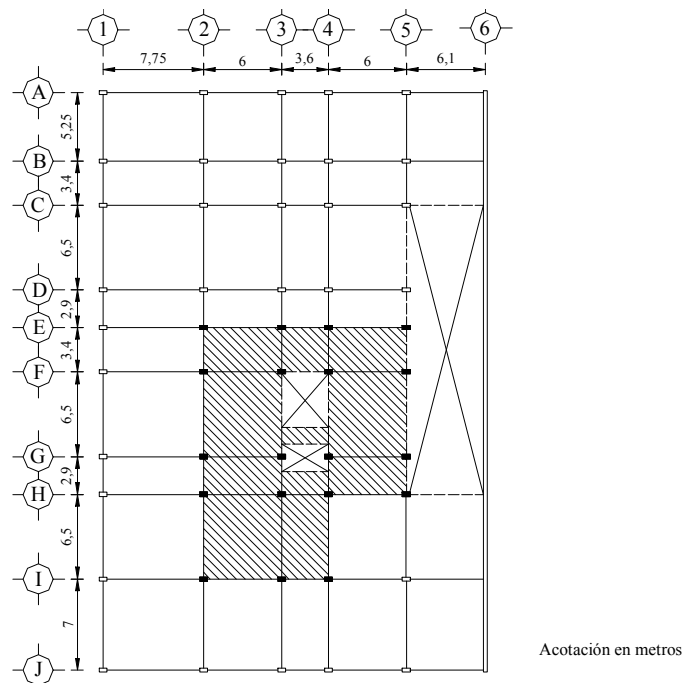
PLANTA DE LA LOSA TAPA
